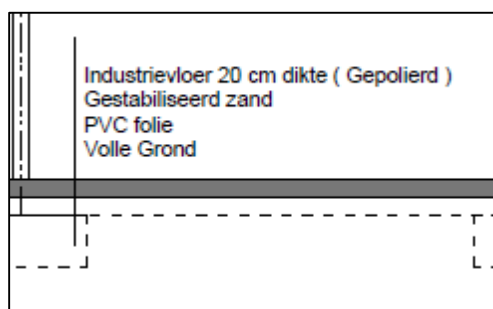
detail uit het doorsnede plan deel winkelruimte zoals aangereikt met aanduiding van de diepte van de funderingszolen en opbouw van de vloer
